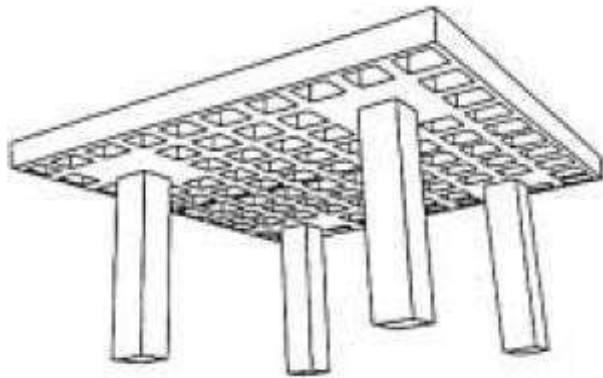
Vista de la Construcción de una Losa Reticular con Casetones de Poliestireno, Fuente: <http://www.arqhys.com/articulos/losas-nervadas->
